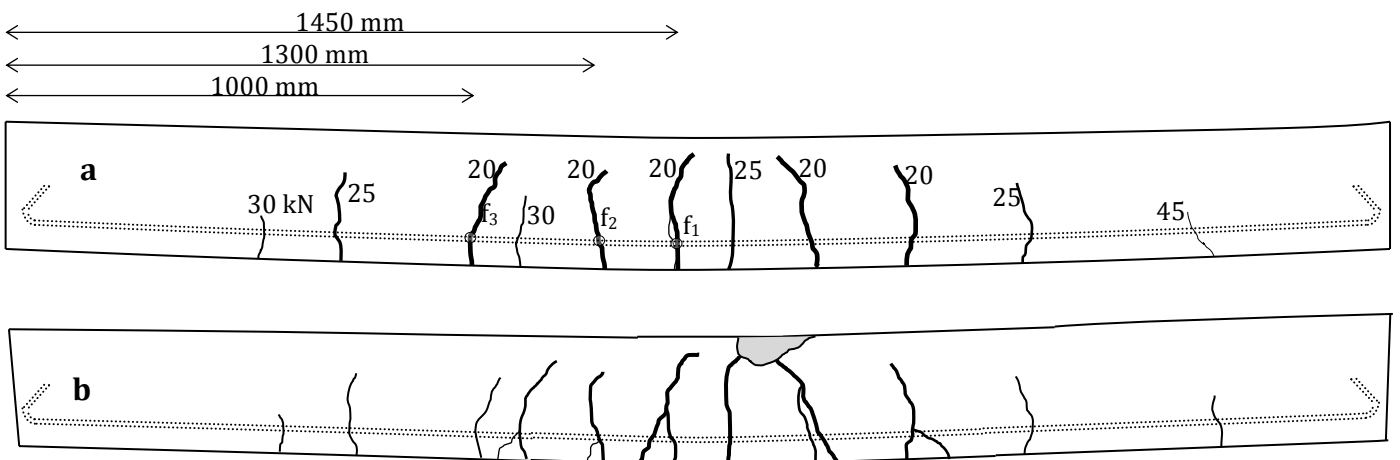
Carte de fissuration de la poutre Y120-0 (a) à l'endommagement (34.3 kN.m), (b) à la ruine.
